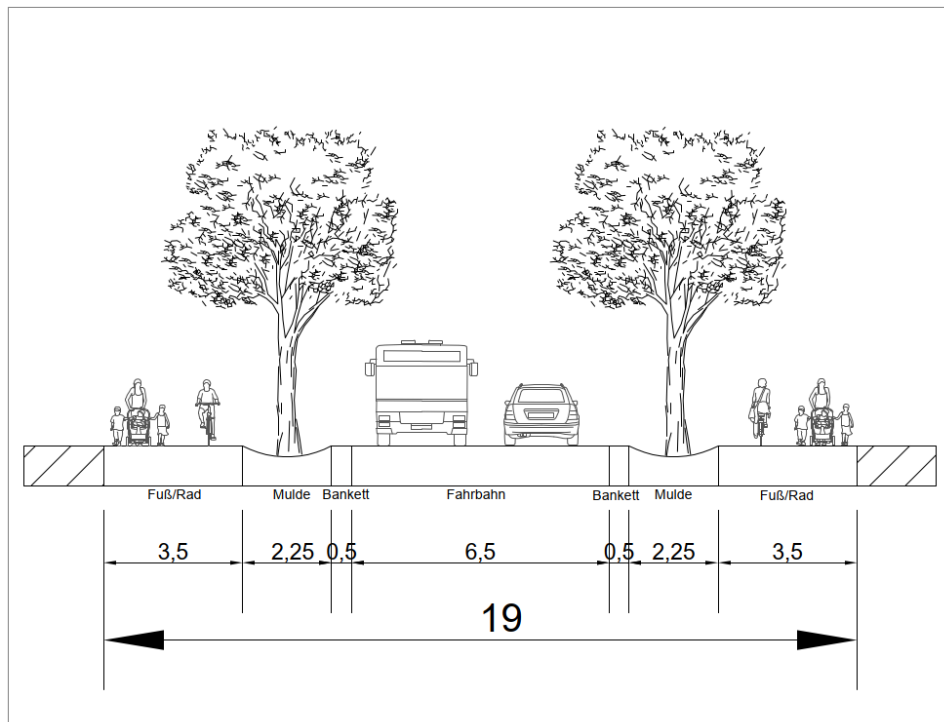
Straßenquerschnitt 19m (Planstraße 3 & 4)
